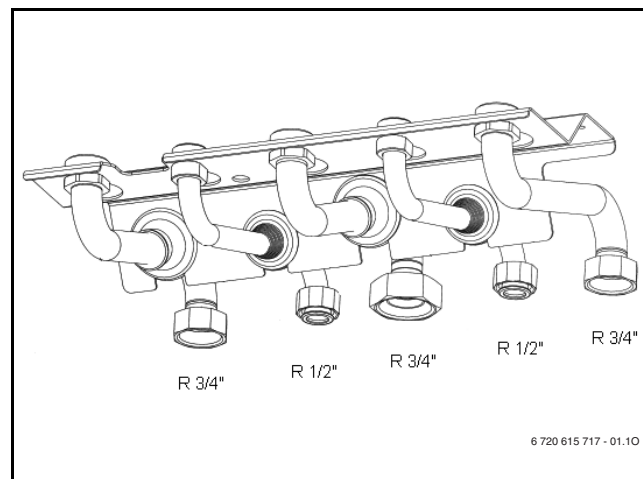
Montážna šablóna (horizontálne pripojenie)
